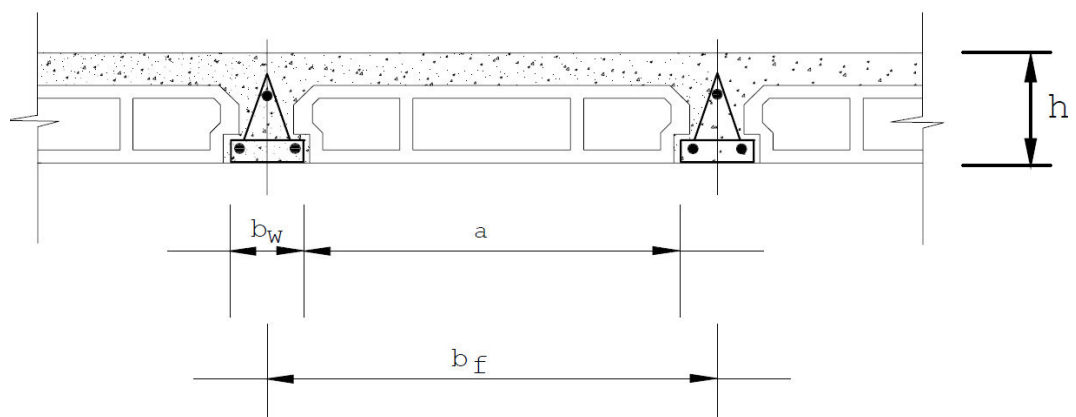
Distribuição dos elementos da laje pré-fabricada
